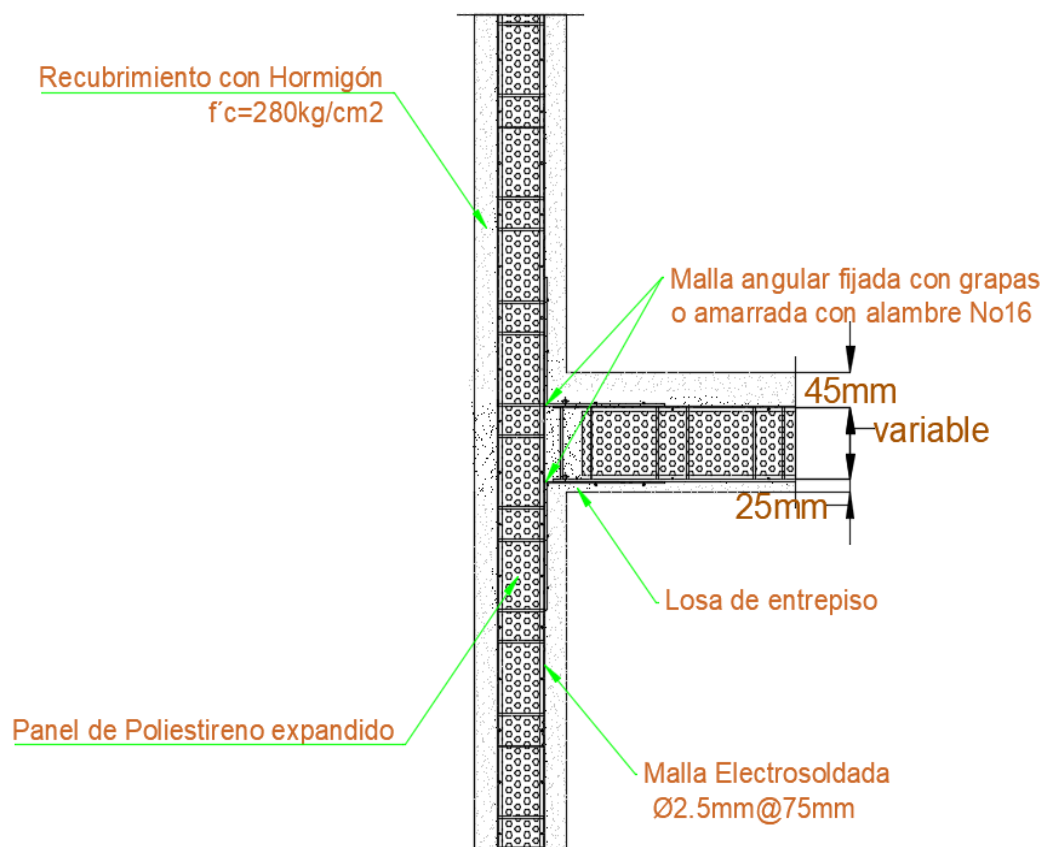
Detalle unión de paredes exterior con losa de entrapiso (PLANTA)
